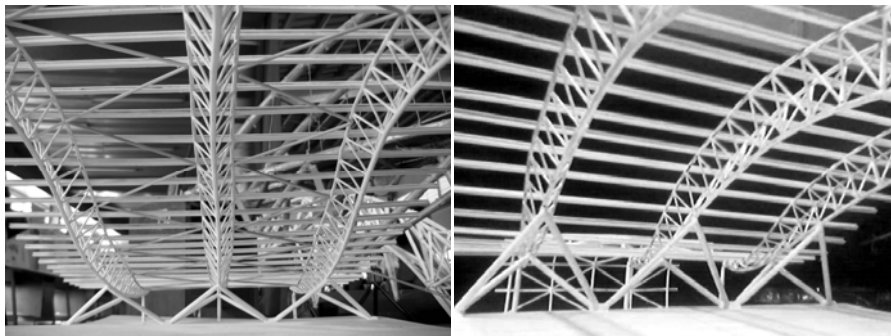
Vistas de maqueta de celosías principales con apoyos triangulados
